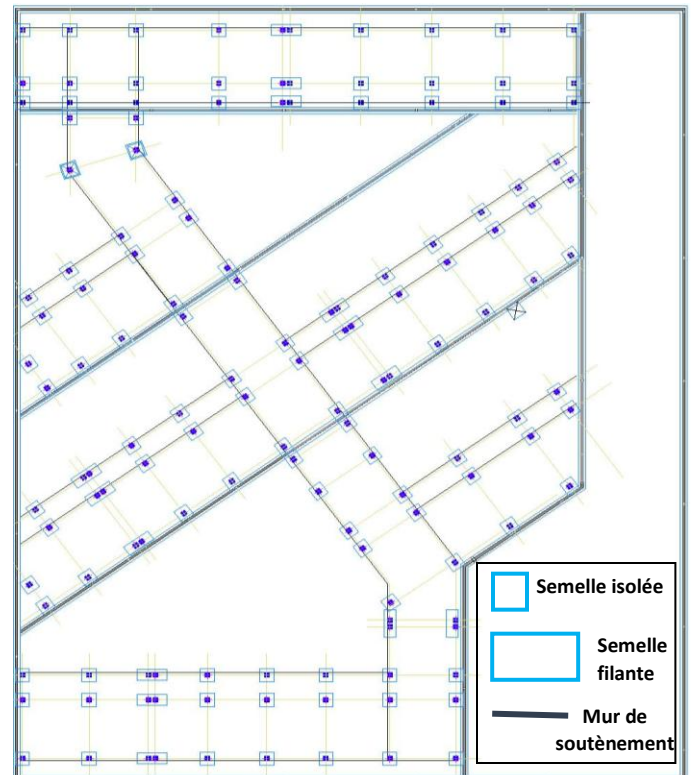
Plan des fondations + le positionnement des murs de soutènement (source: auteur)
